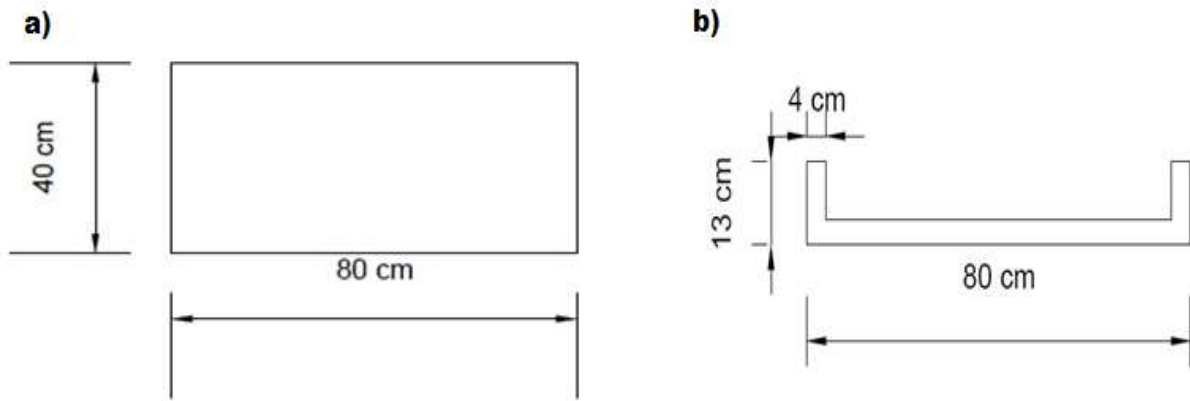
Diseño del muro de adobe a escala reducida: a) vista frontal; b) vista en planta.
